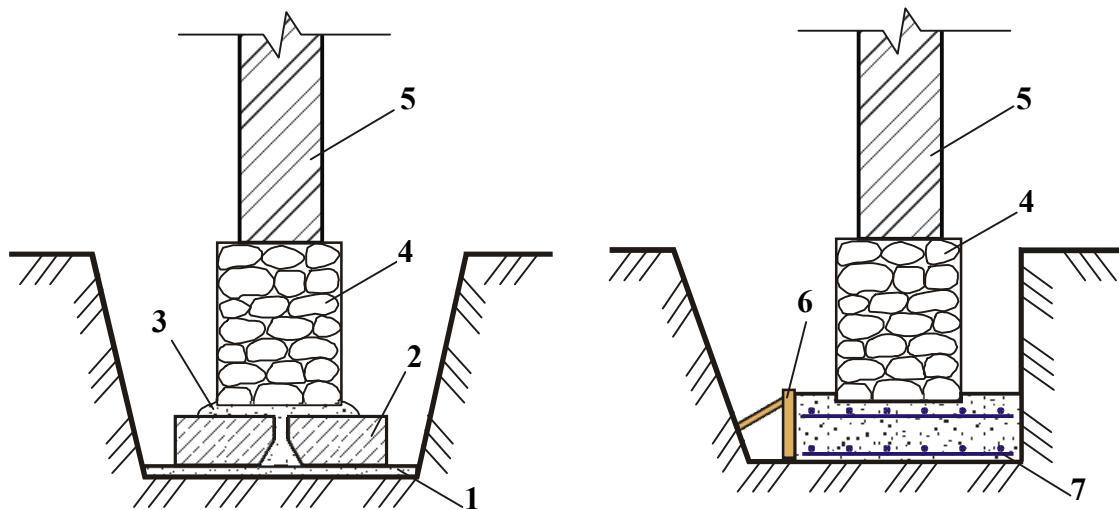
Розширення підошви фундаменту: а – шляхом підведення залізобетонних плит; б – шляхом улаштування монолітної залізобетонної подушки; 1 – ущільнена ґрунтована підготовка; 2 – залізобетонні плити; 3 – цементно-піщаний розчин; 4 – фундамент; 5 – стіна; 6 – опалубка; 7 – арматурна сітка
